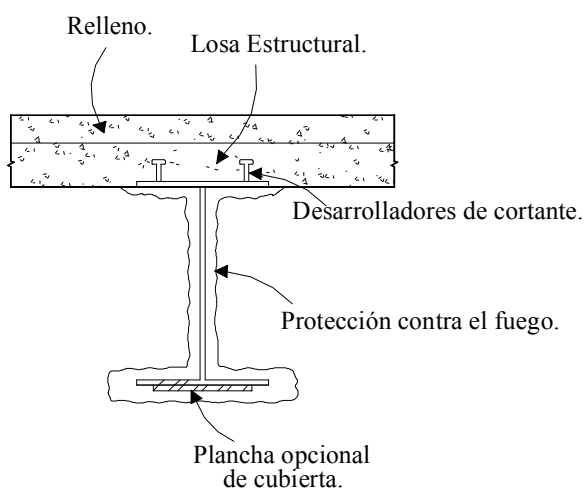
LOSA DE CONCRETO COLADA EN SITIO SOBRE VIGAS DE ACERO.
